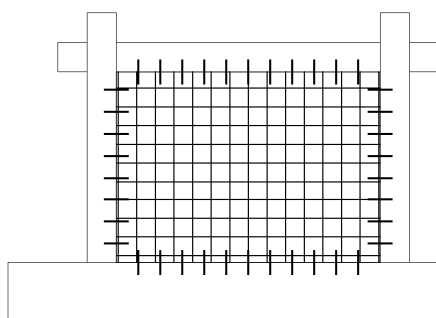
Ojačanje ispuna mikroamiranim betonom
